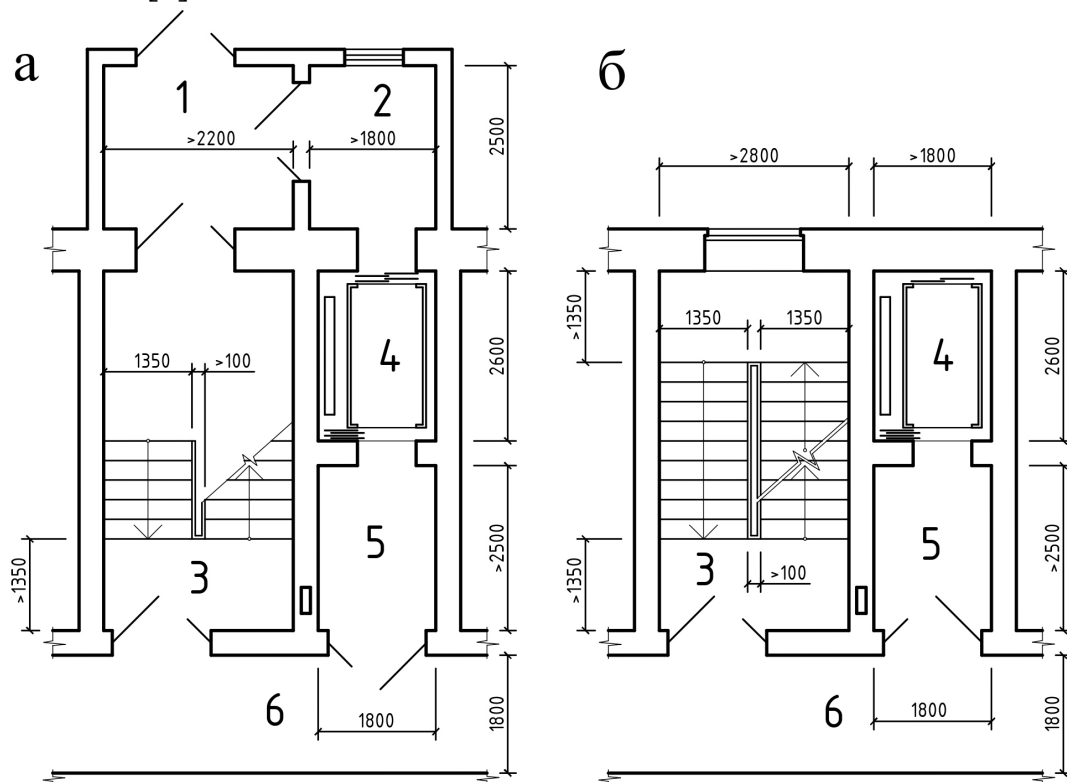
Схема планувального рішення організації пожежобезпечної зони для МГН відповідно до вимог п.3.35 [8] у багатоповерховому секційному будинку умовною висотою до 26,5 м: а – план першого поверху; б – план типового поверху; 1 – тамбур; 2 – протипожежний тамбур-шлюз 1-го типу; 3 – сходова клітка типу СК1; 4 – пожежний ліфт з прохідною кабіною; 5 – протипожежний тамбур-шлюз 1-го типу; 6 – коридор, що веде до квартир
